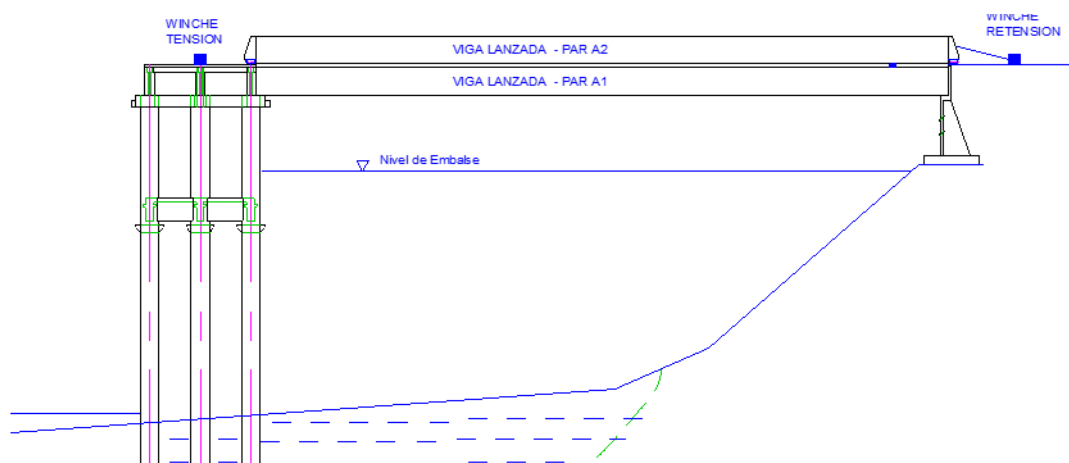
Lanzamiento del segundo par de vigas por encima del primer par de vigas metálicas
